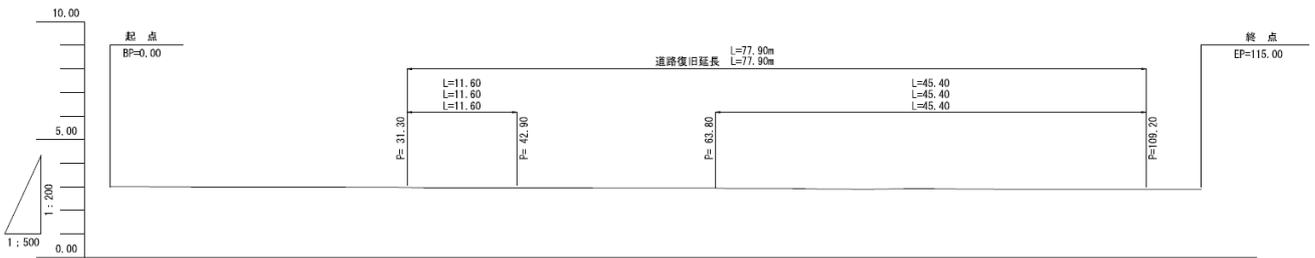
No.1 道路の平面図(被災後_復旧後)
